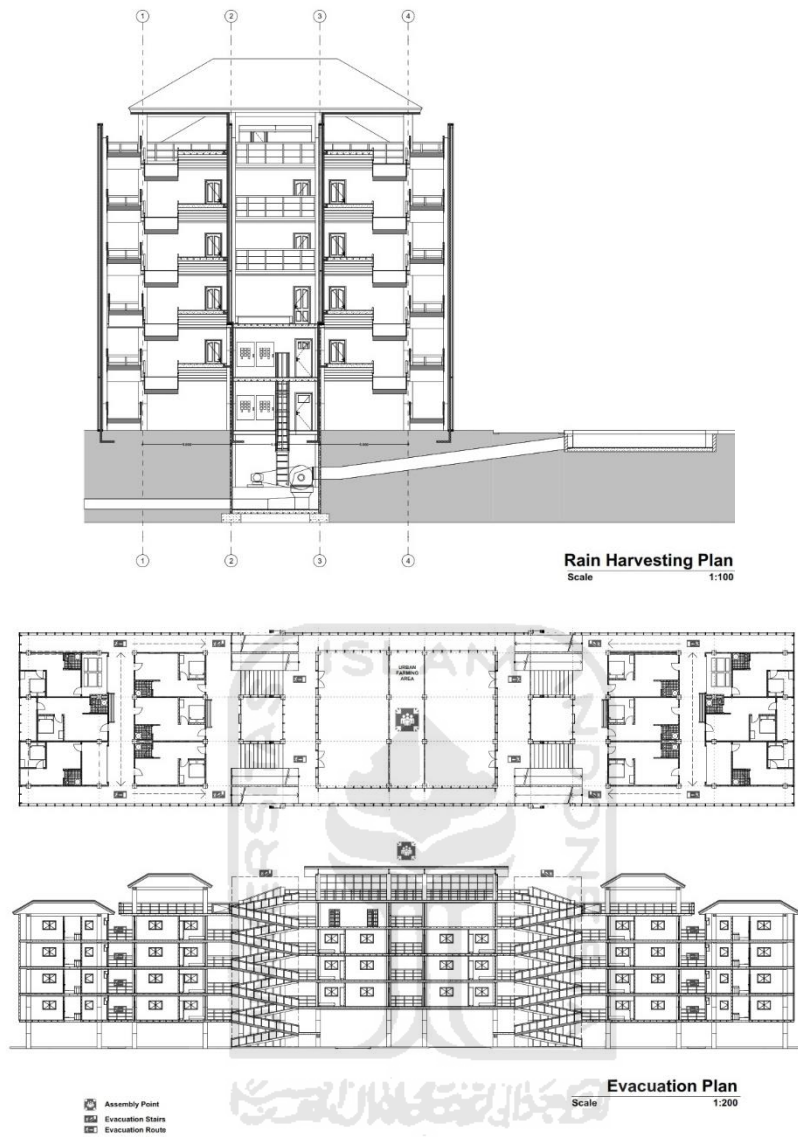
Potongan Bangunan Hasil Desain
